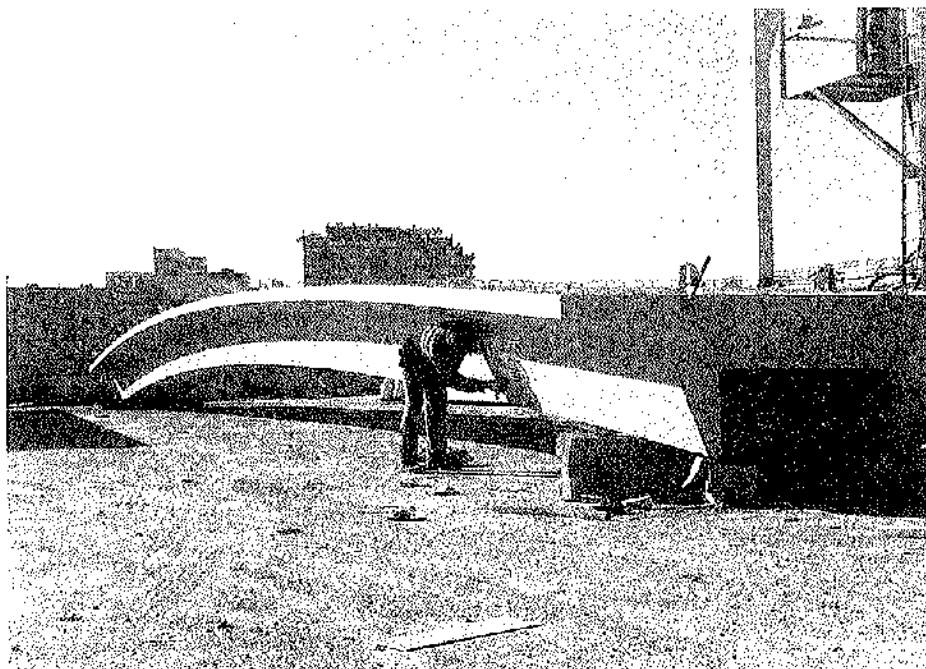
Viga-cajón cerrada y directriz curva para pasarela peatonal en Zaragoza. Longitud de la viga: 34,36 m.
